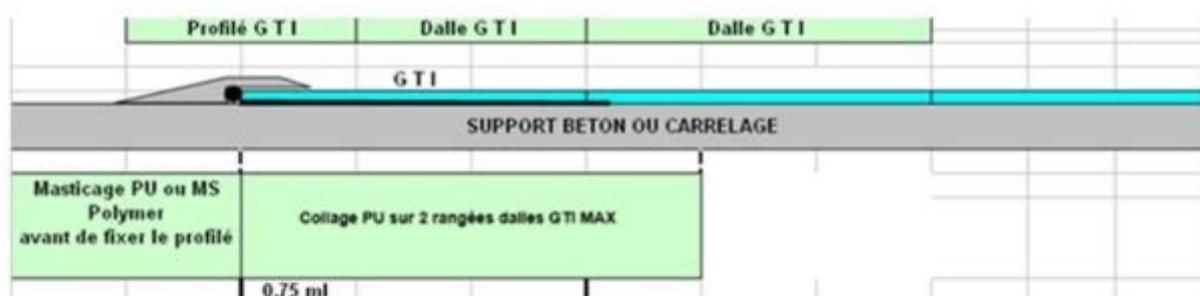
schéma de mise en œuvre du raccordement entre les dalles GTI MAX CONNECT et le carrelage
